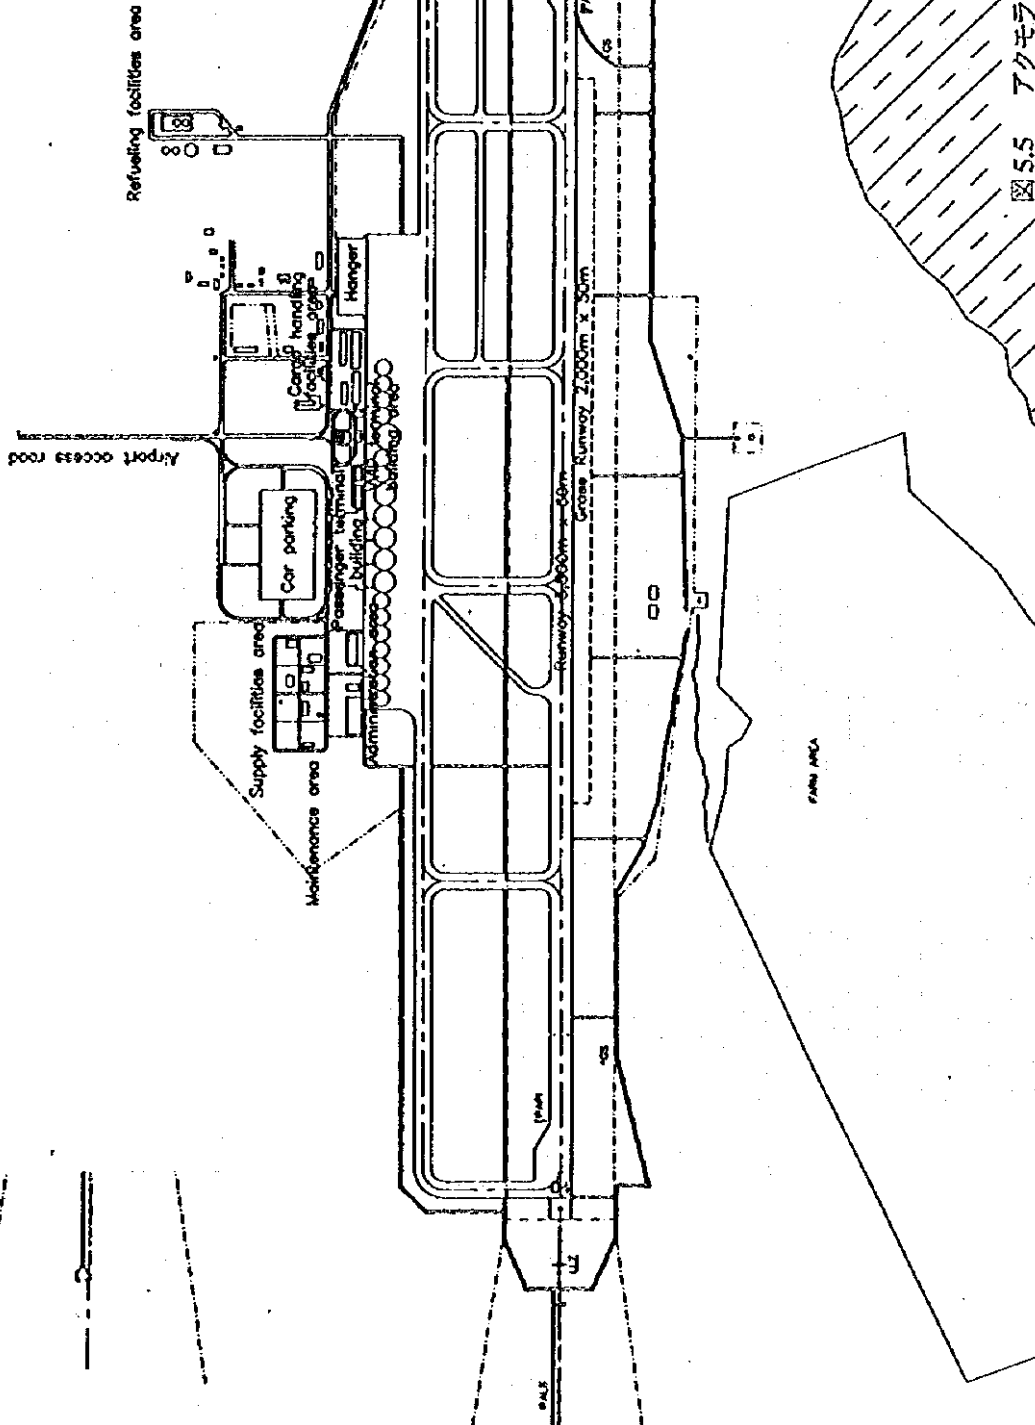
アクモラ国際空港 長期計画平面図 (目標年次 2020 年)
